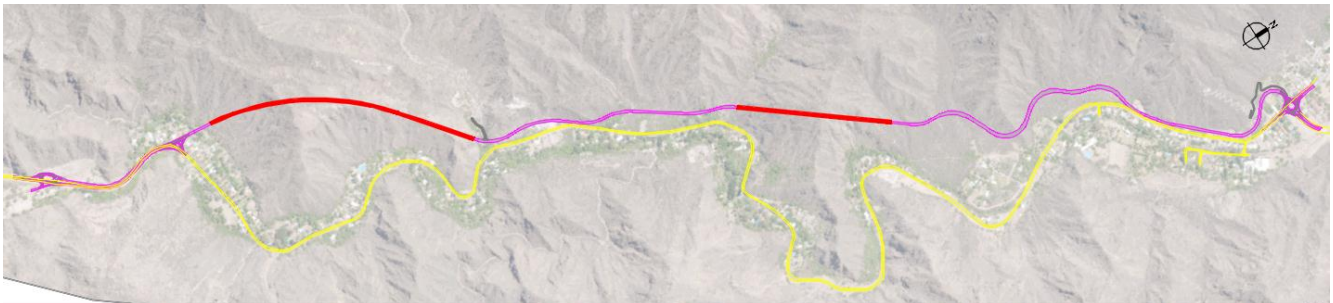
Trazado Proyectado (Amarillo: Traza Existente - Rojo: Proyecto)
